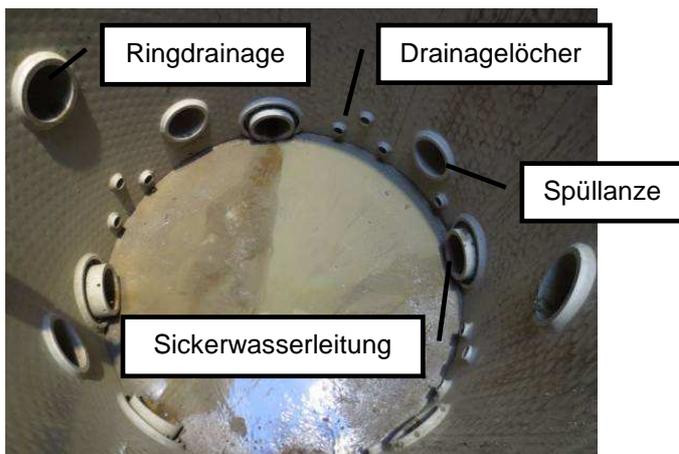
Schachtunterteil (Drainageschacht) mit Anschluss-/Drainageöffnungen
